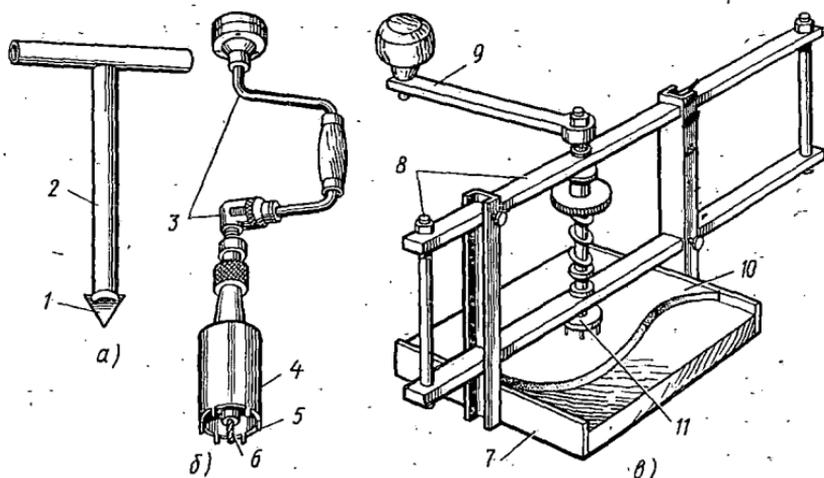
Инструменты и приспособления для сверления отверстий в керамических плитках:
